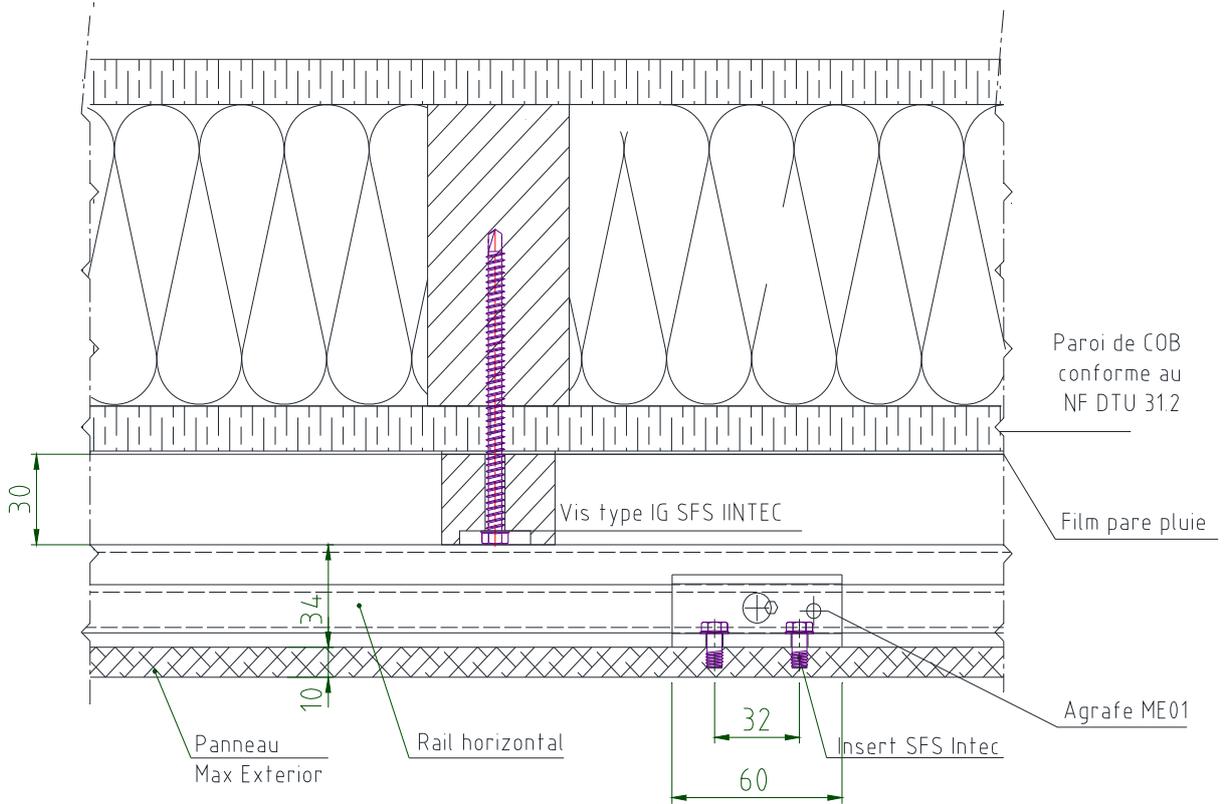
Détail fixation du rail sur tasseaux (Coupe horizontale)
